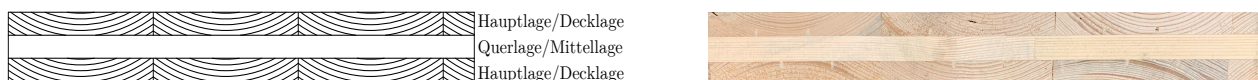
Schematischer Aufbau und Foto einer dreilagigen Brettsperrholzplatte
